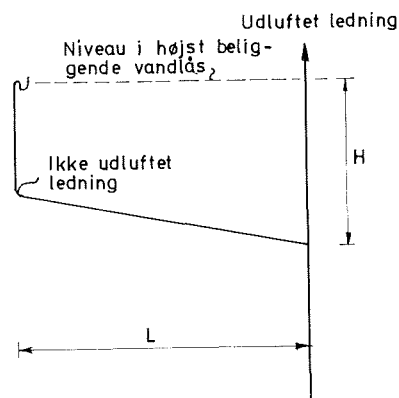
Højde- og længdebegrænsninger for ikke-udluftede spildevandsledninger, der dimensioneres efter fig. 4.5.
